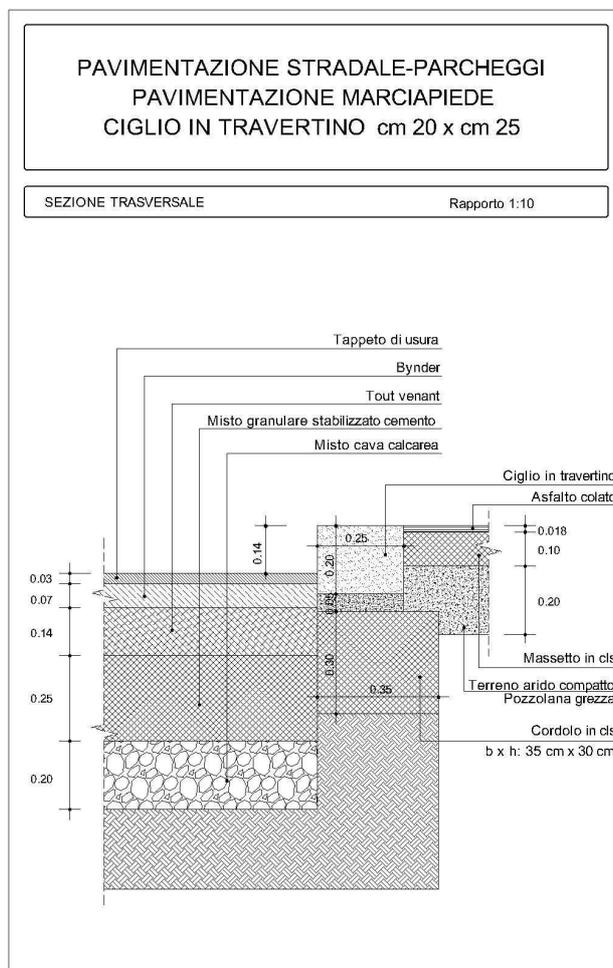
Pacchetto stradale rete viaria, parcheggi e marciapiedi
